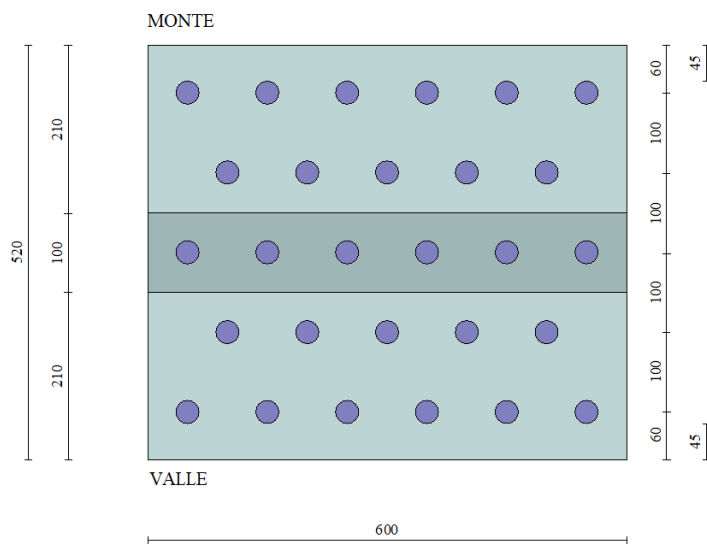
Muro Tipo E: disposizione dei micropali di fondazione.
